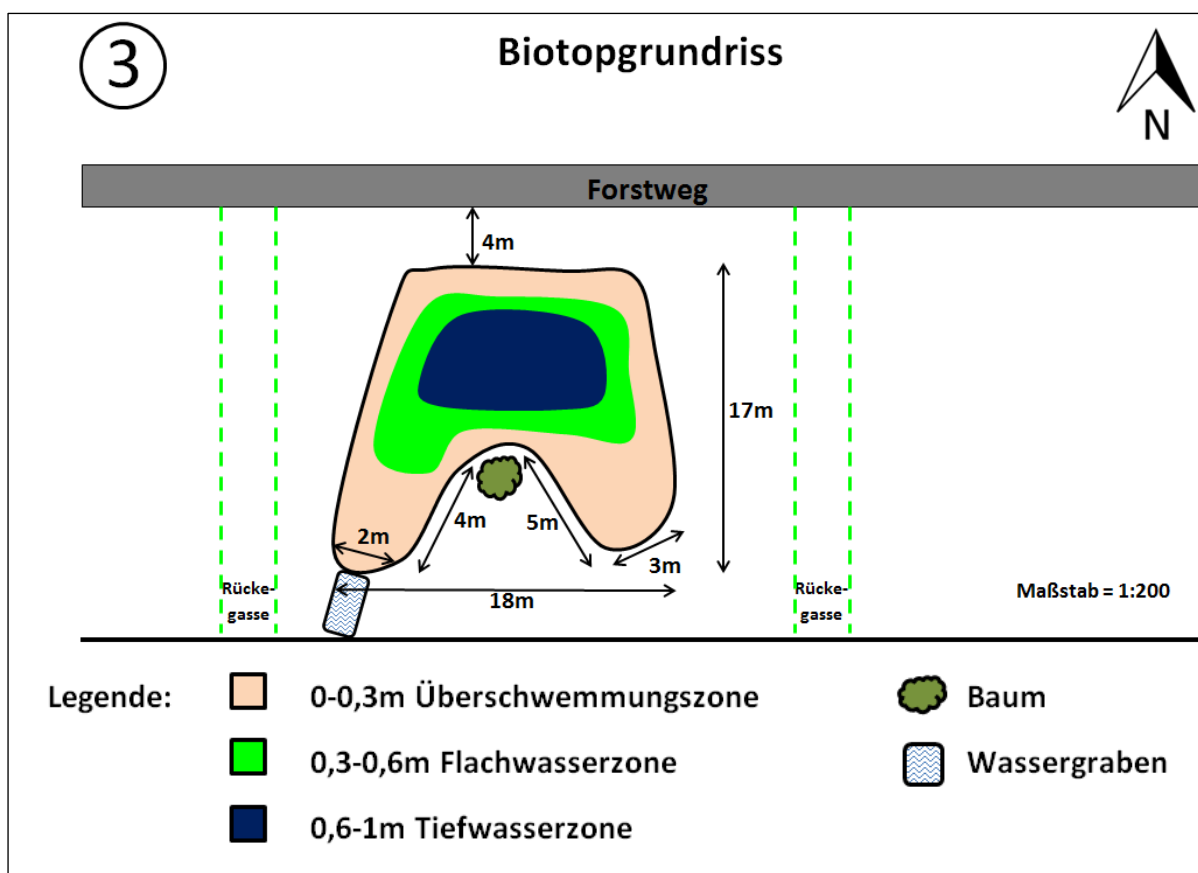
Grundriss von Biotop Nr. 3
